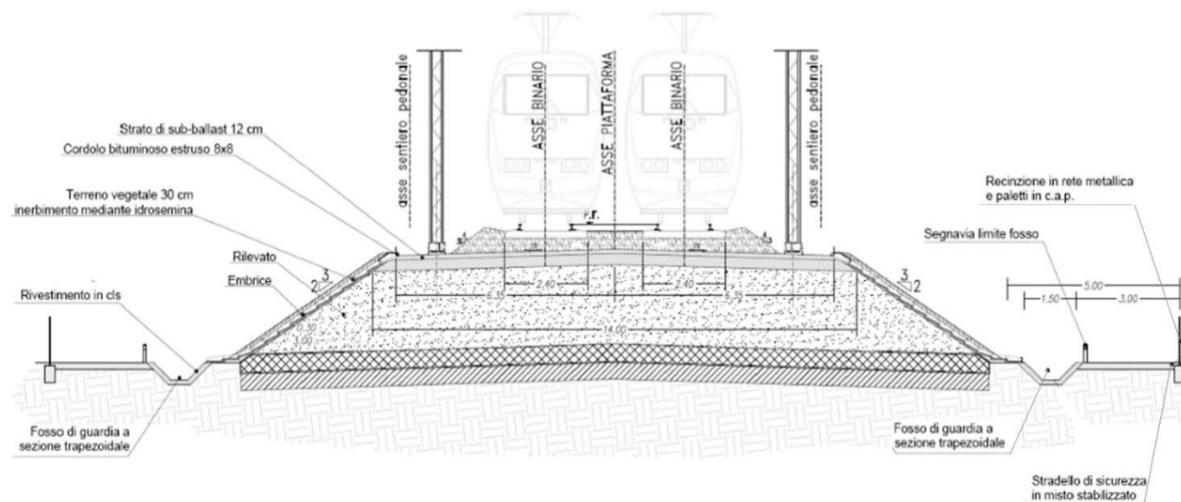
Sezione ferroviaria in rilevato a doppia linea
